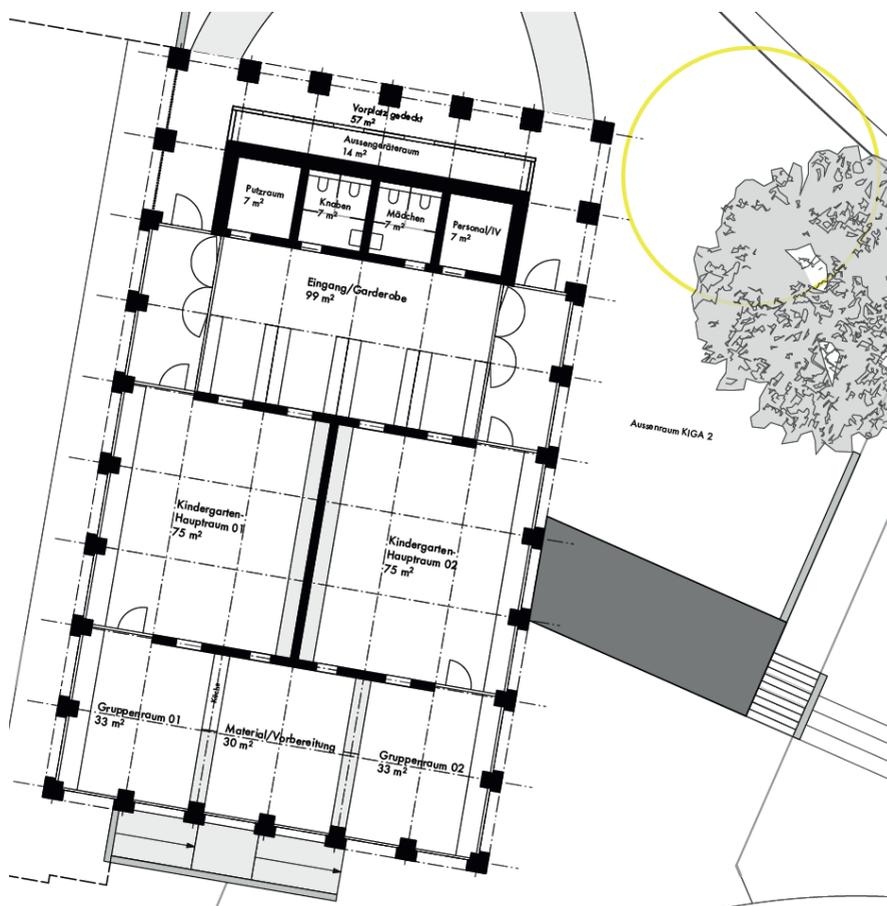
Grundrissplan Doppelkindergarten
